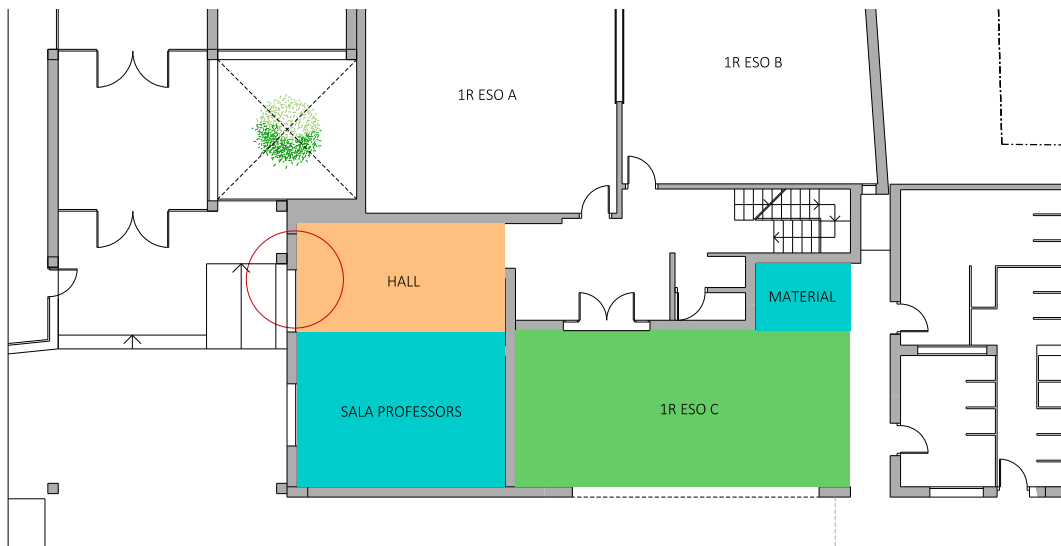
Proposta 3, Edifici C, Planta Baixa. Font: Elaboració pròpia.
